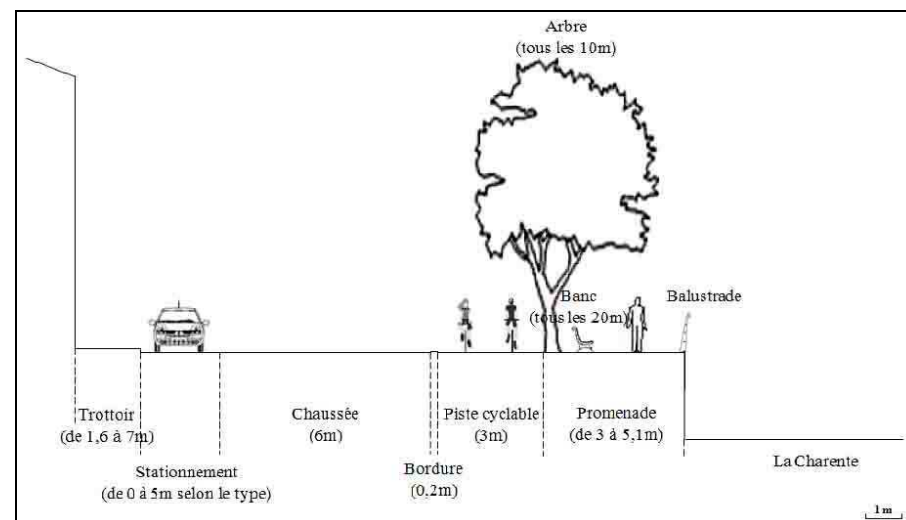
Profil de voirie n°3 - Avec stationnement et sans encorbellement
